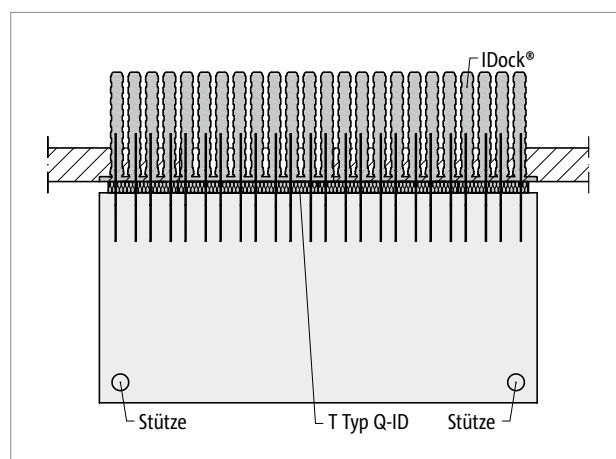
Schöck IDock®: Balkon mit Stützenlagerung; Anschluss mit Schöck Isokorb® T Typ Q-ID
